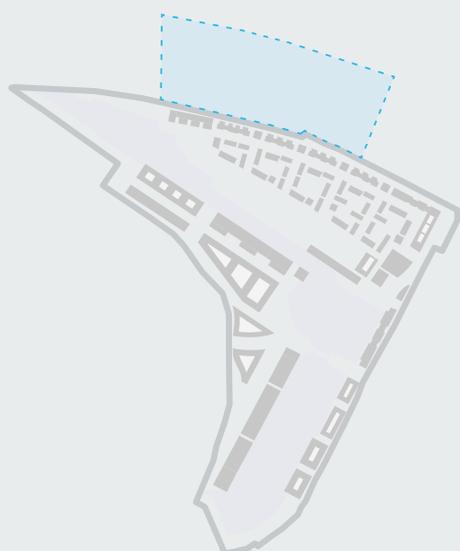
Lageplan Neue Elbquerung Grasbrook
